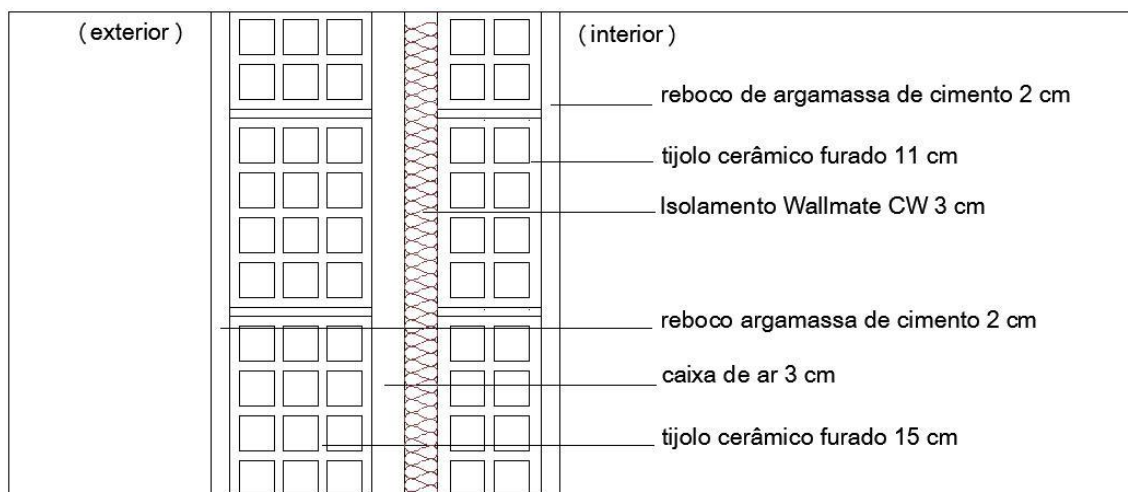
Pormenor construtivo de parede exterior da solução existente
